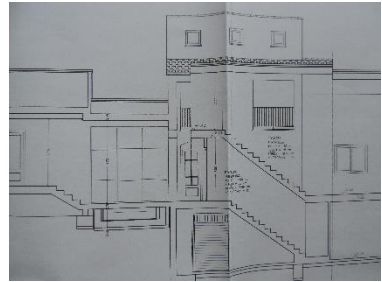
Extracto del plano de cimentación. Fuente propia. 2018
